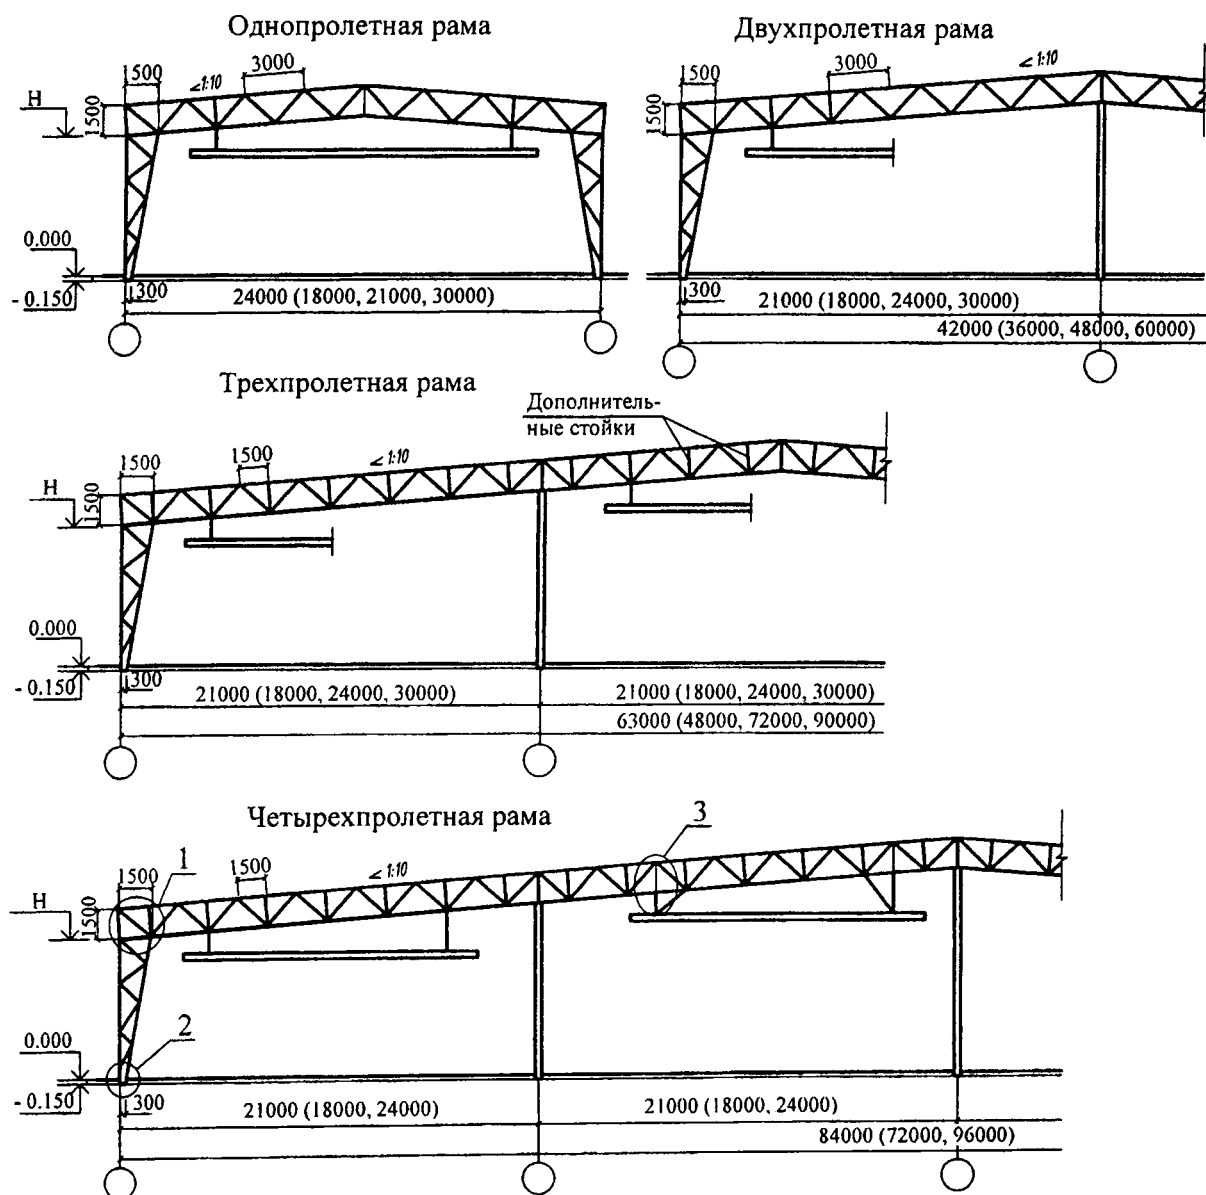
Габаритные схемы зданий с применением рам УНИТЕК
